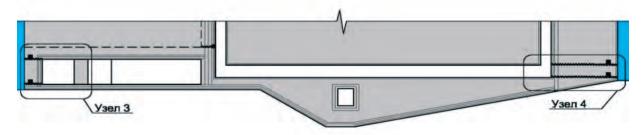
Схема расположения швов бетонирования и монтажа гидроизоляционного жгута «Пенебар» и «Скобы крепежной металлической» в местах сопряжения стен и перекры-тий в потернах, смотровых шахтах и соединительных коридорах здания ГЭС (фрагмент 2 на рис. 6.1.1)
